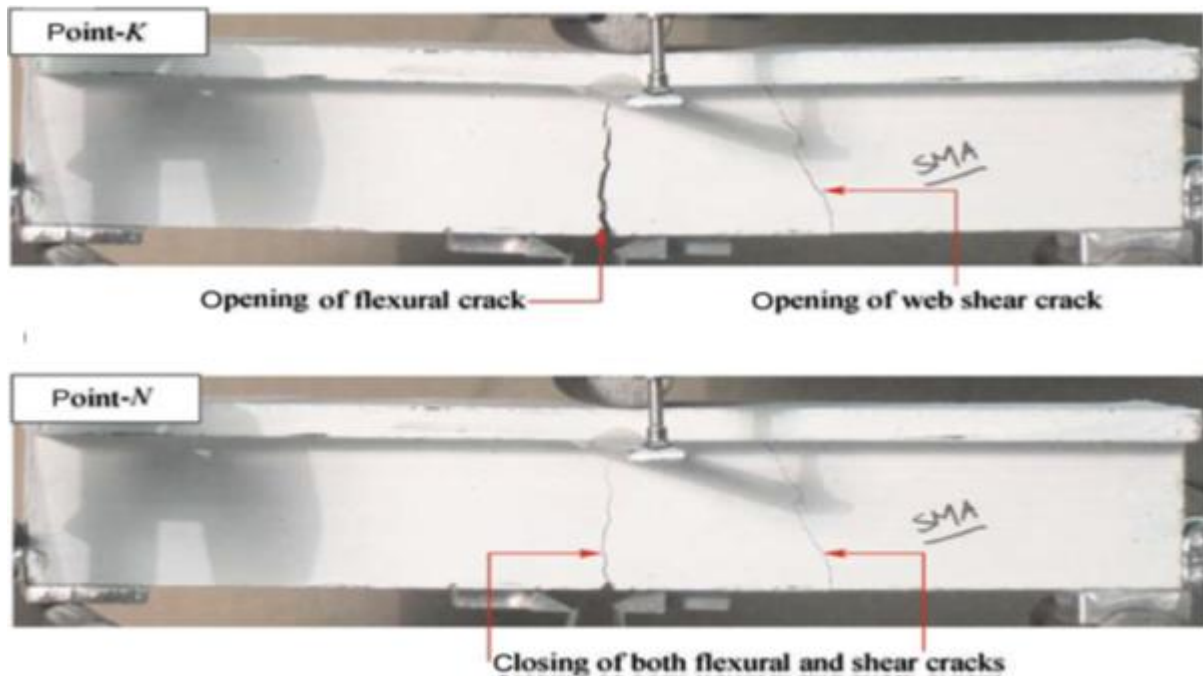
Étapes des essais de flexion de la poutre en T (Zafar,2013).
